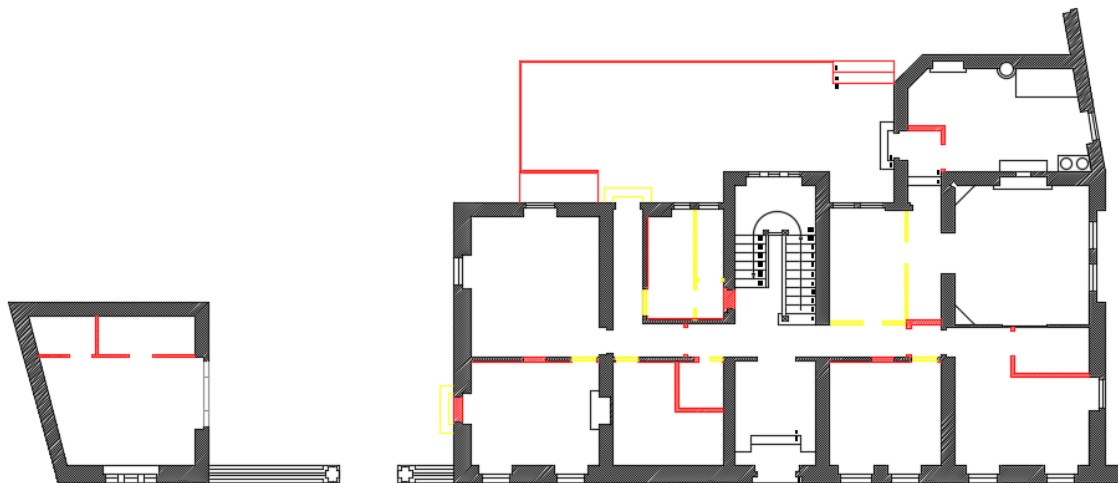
Planta de Alterações, Piso Rés-do-Chão
